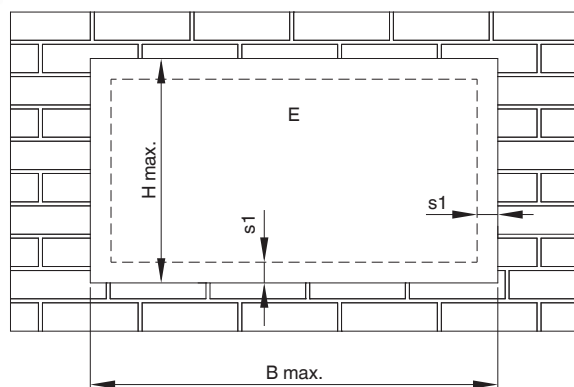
EK-JZ Montage du système de panneaux enduits dans un mur plein EI 90 S
